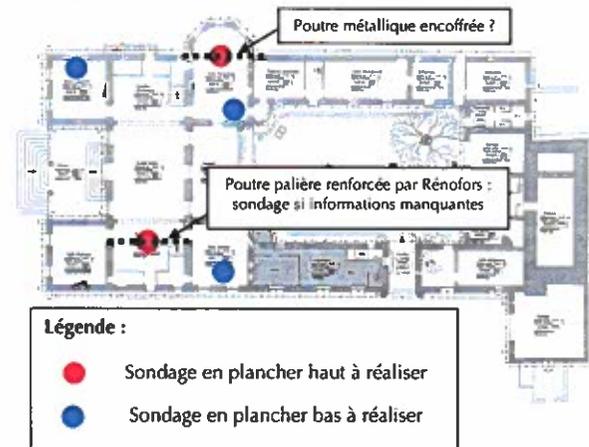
Plan du rez-de-chaussée, sondages structurels à prévoir
